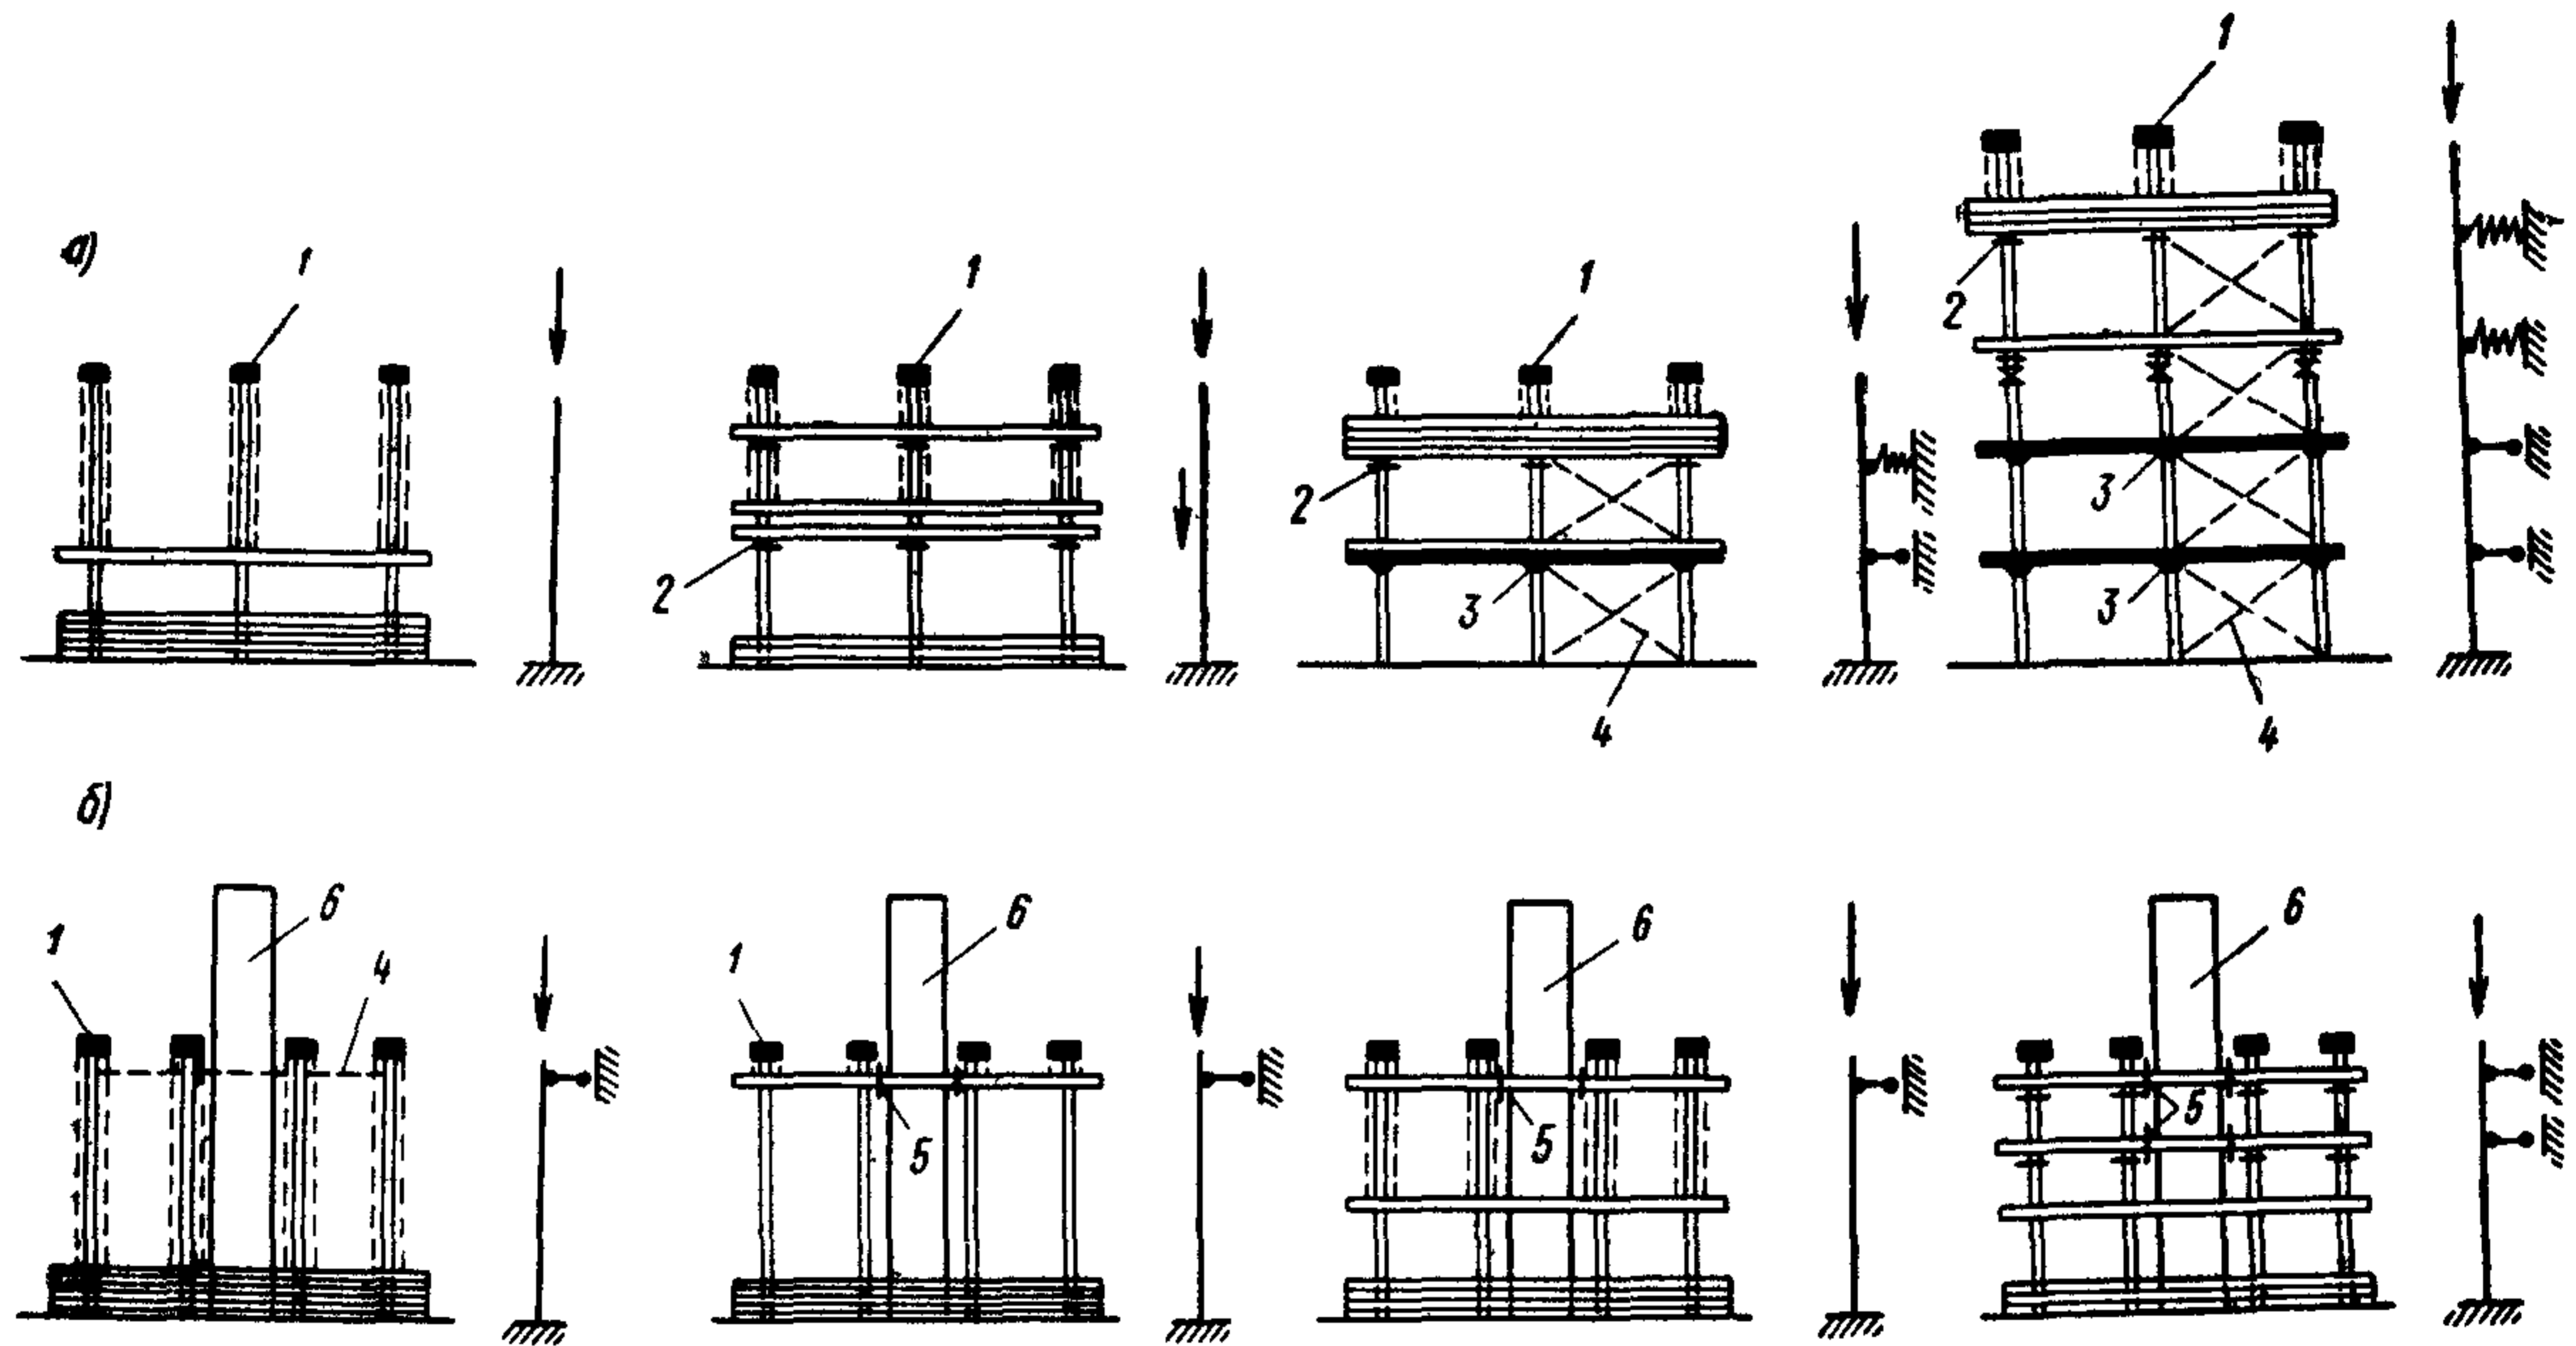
Расчетные схемы каркаса в процессе монтажа
